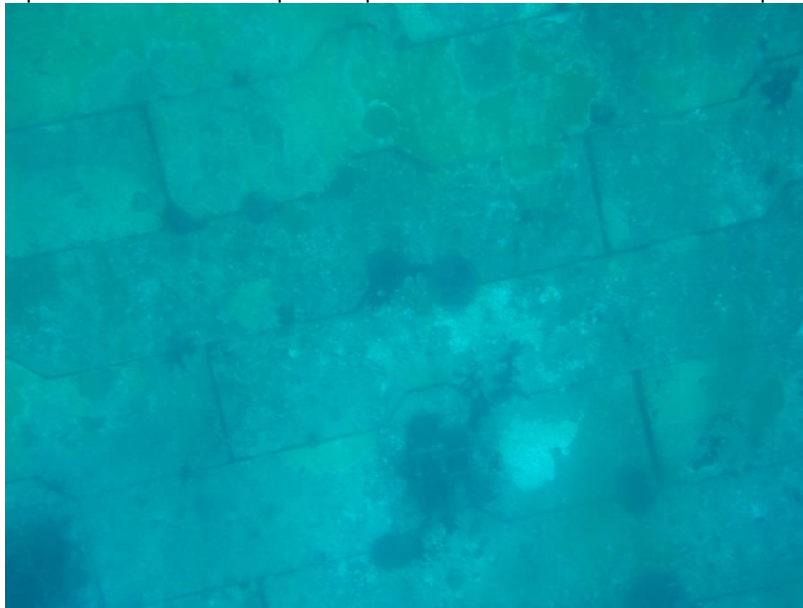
Estructura derrumbada por el Huracán Wilma, construcción por medio de elementos prefabricados
